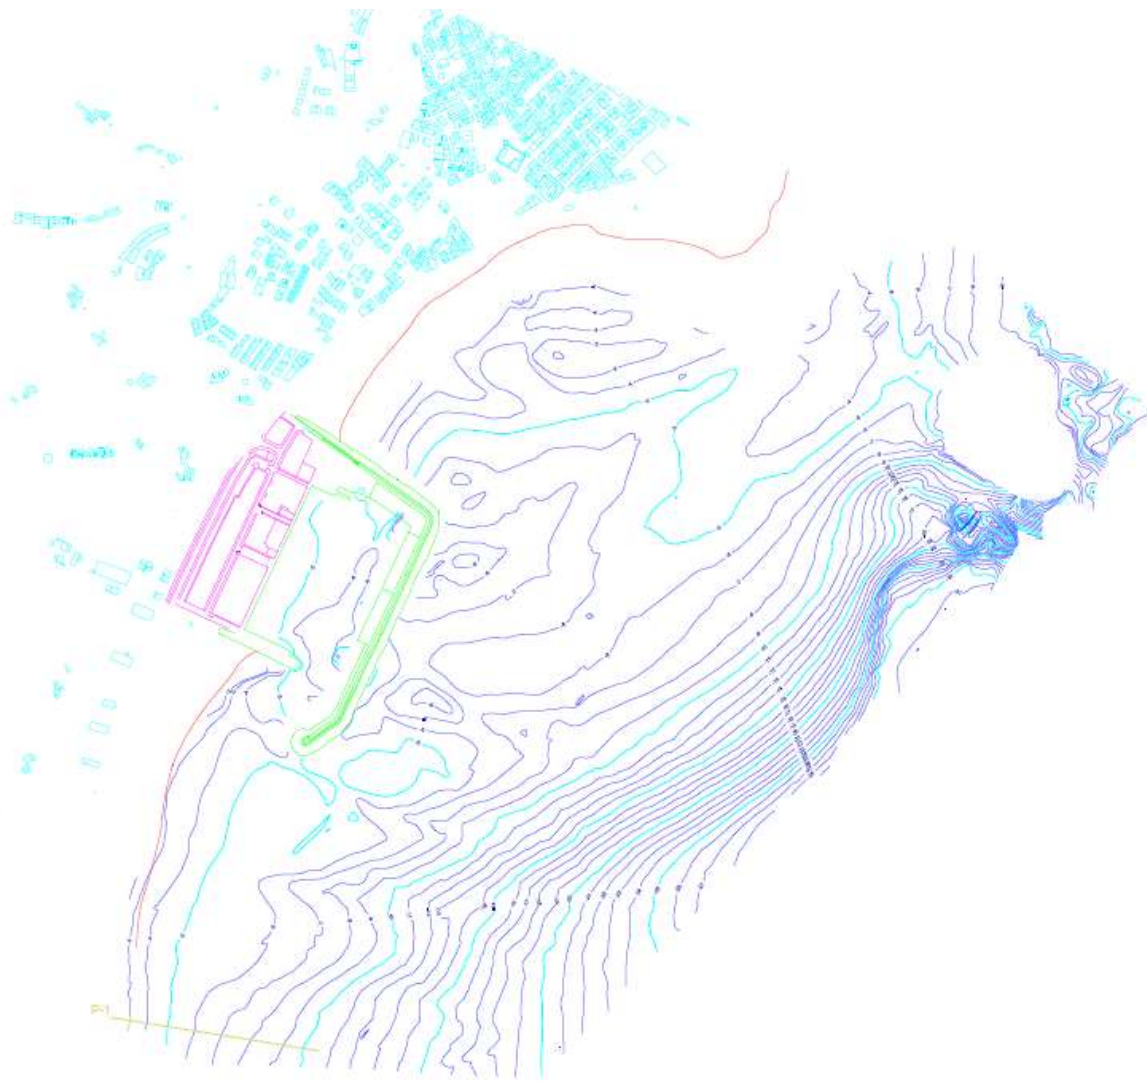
Detalle de la batimetría de la zona de proyecto. Fuente: APPA.
